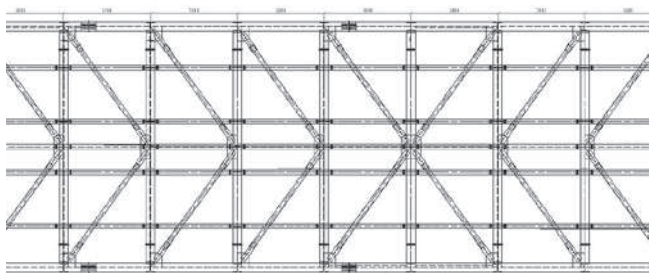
Konstrukcja kratowych elementów pionowych galerii
